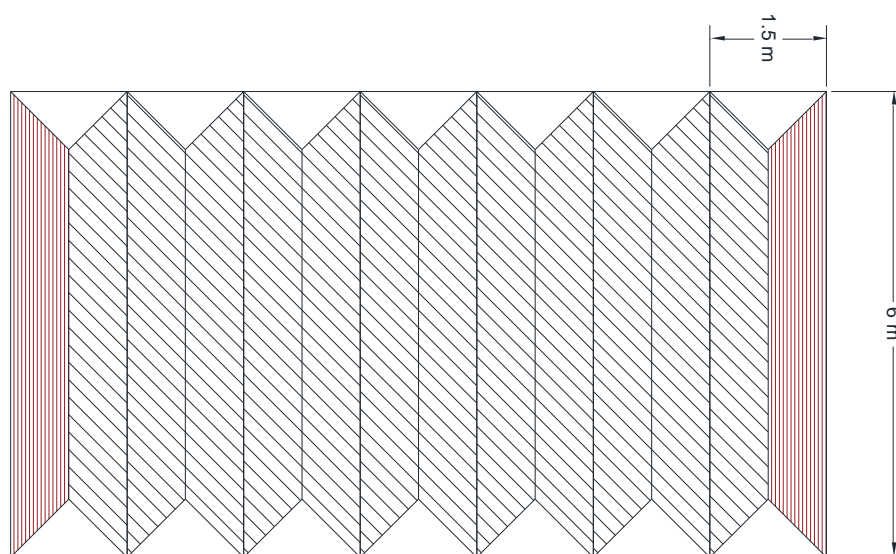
Vista en planta de cubierta en donde se observa las areas tributarias.
